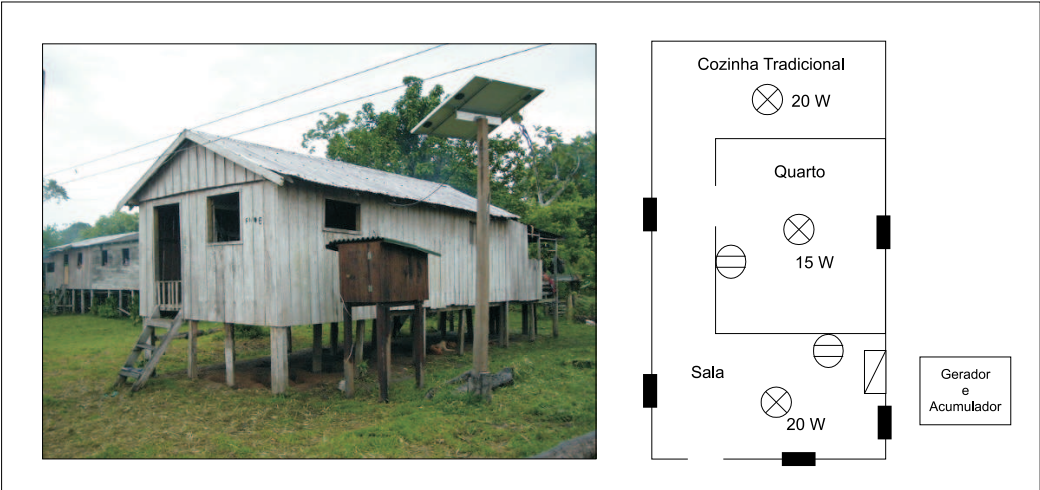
Vista externa do SFD18 e planta aproximada do domicílio.
